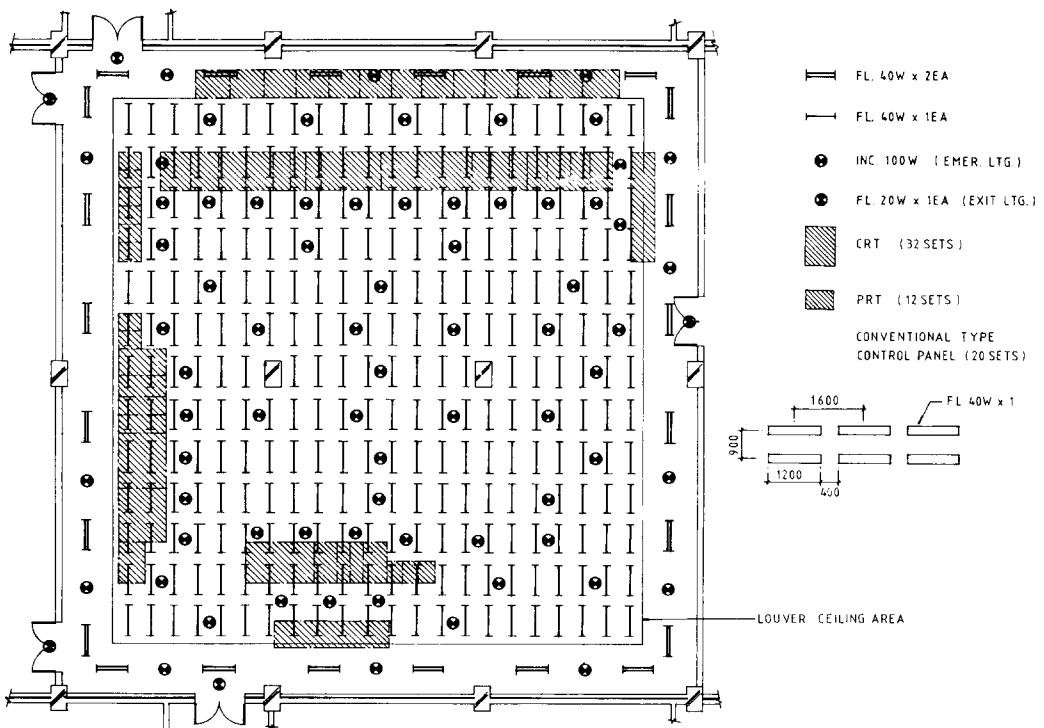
LIGHTING PLAN FOR CENTRAL CONTROL ROOM.
